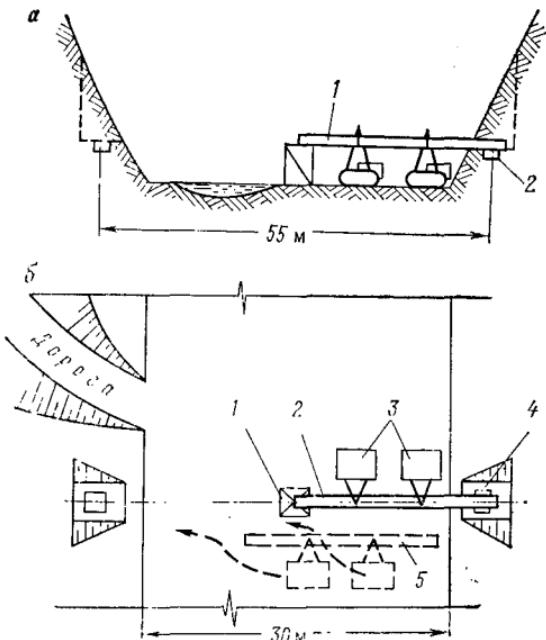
Схема монтажа перехода через реки с крутыми берегами:
